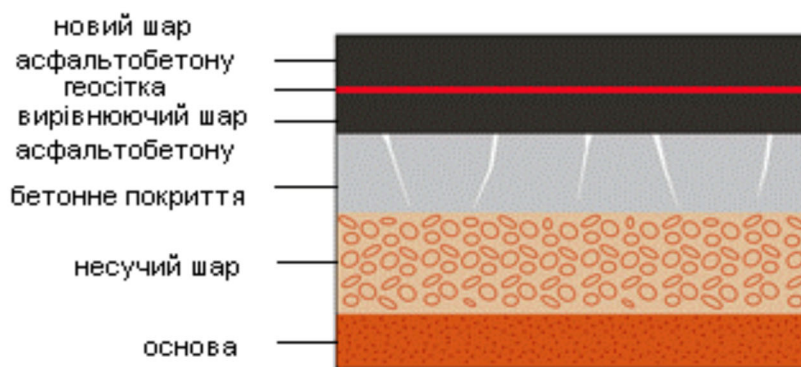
Армування асфальтобетону, покладеного на бетонне покриття
